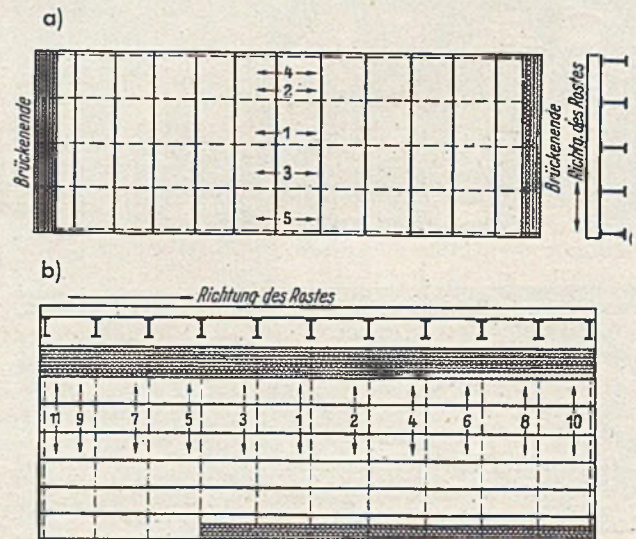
Plan für die Baustellenschweißung bei a) quer- und b) längsliegendem Rost.
